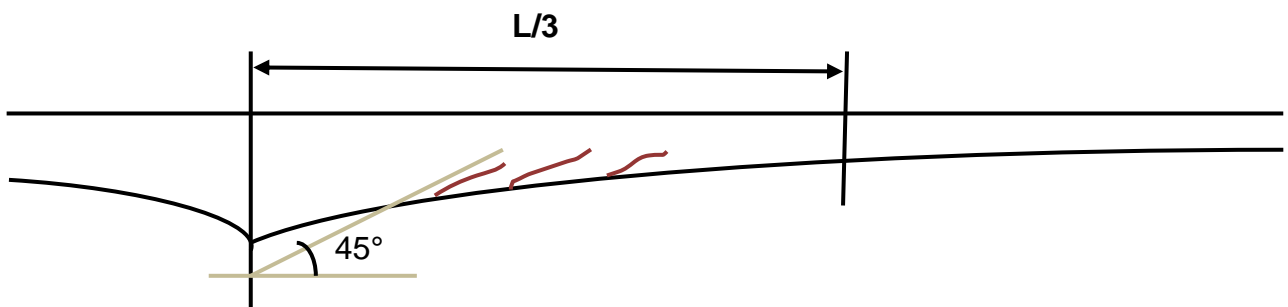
fissuration d'effort tranchant dans un pont caisson
